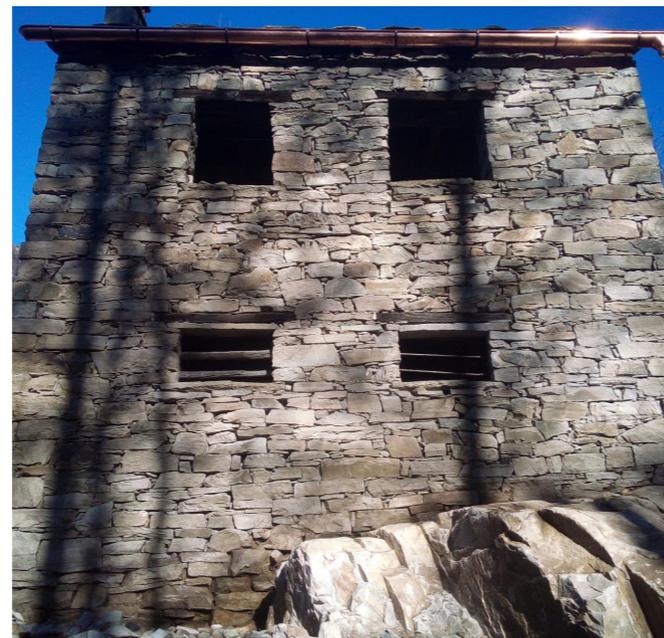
Facciata Sud pre-interventi (Foto di Yann Crivelli)
